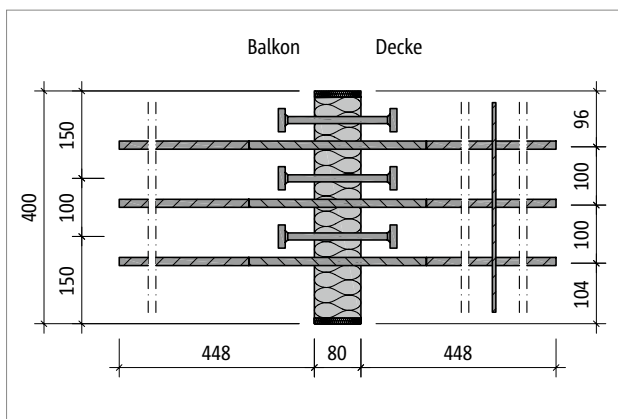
Schöck Isokorb® T Typ QP-V9: Produktgrundriss
